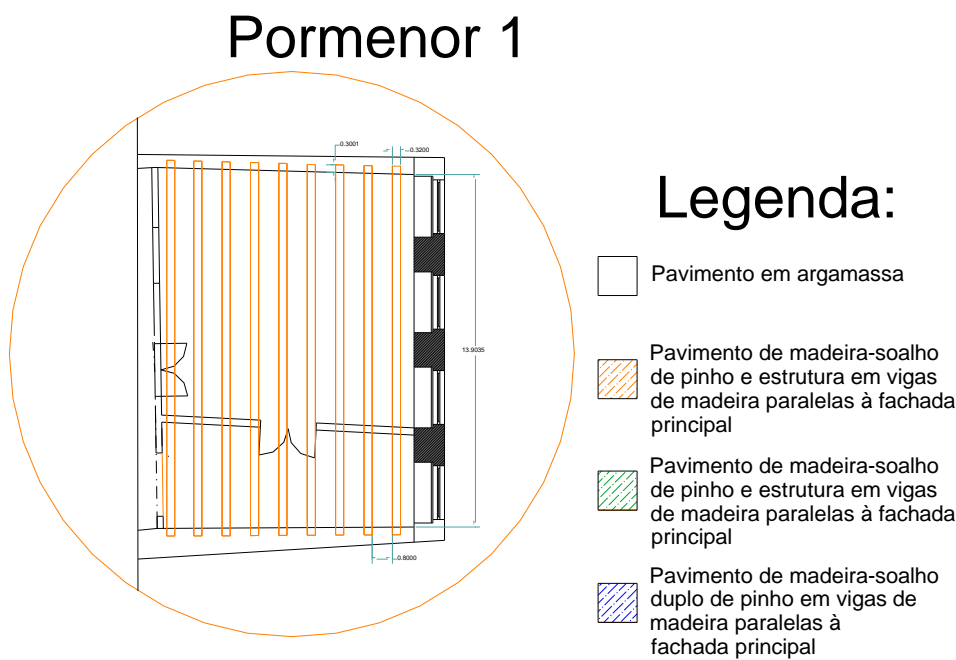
Pormenor 1 e legenda das plantas estruturais
